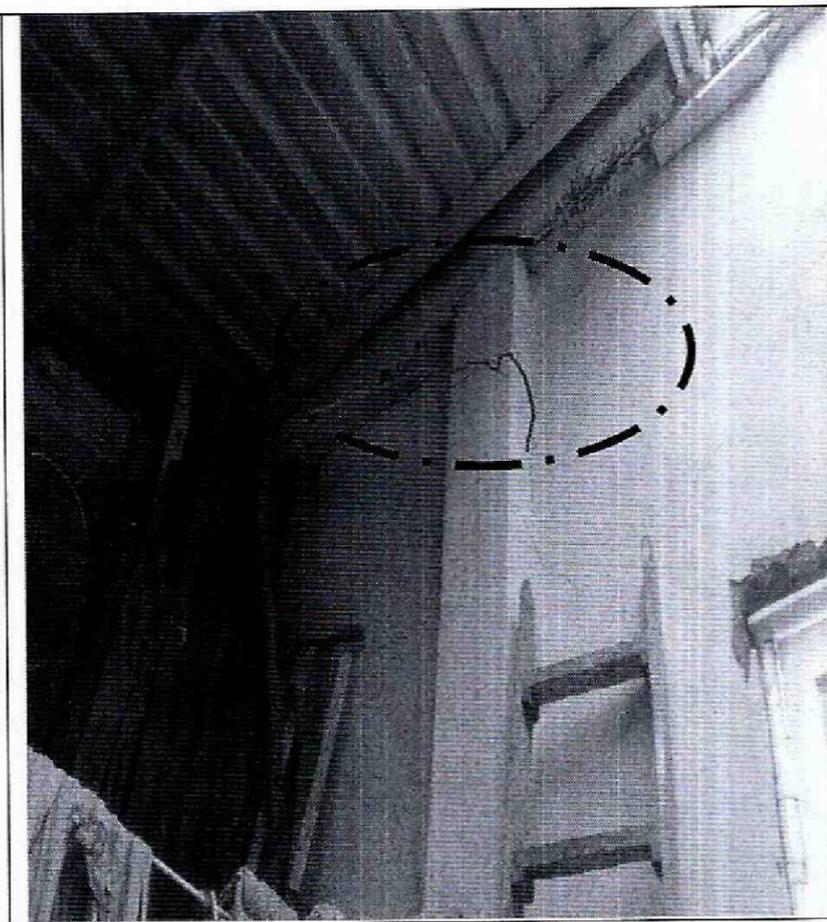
Fisuras identificadas en muros de cerramiento y divisorios en la vivienda de la Calle 137 A No 98 B - 21
